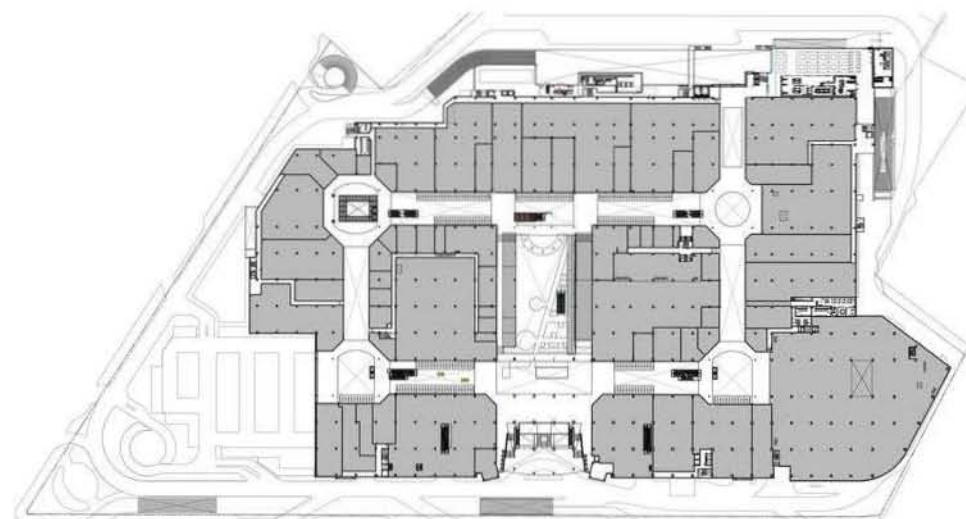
Planta 1 Plaza Parque Vía Vallejo
